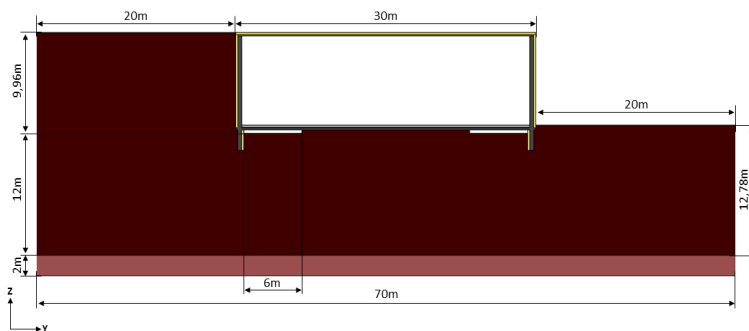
Y-Z Schnitt Gebäudeversion 2; 6 m horizontale Randdämmung, 2 m vertikale Randdämmung
